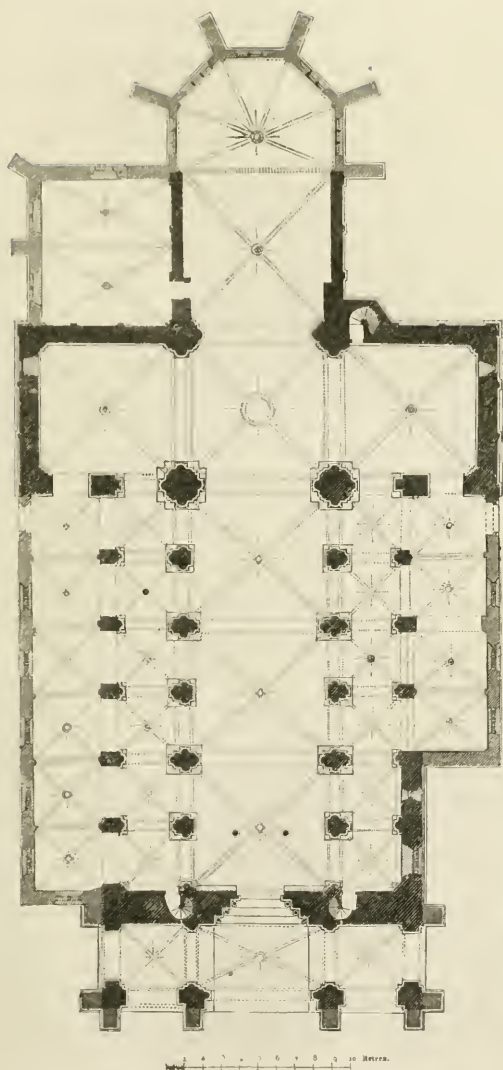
Grundriss der Kirche zu Gebweiler.
